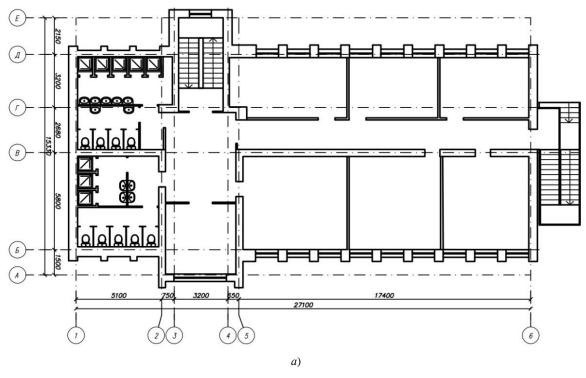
Вариант 19: a – план типового этажа; δ – план первого этажа
